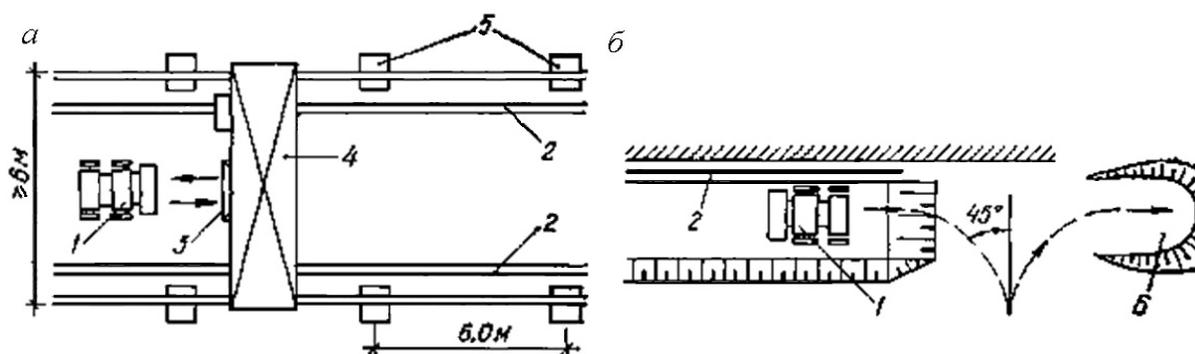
Схемы разработки грунта погрузчиком: *а* – в сочетании с мостовым краном; *б* – с доставкой грунта во временный отвал; 1 – погрузчик; 2 – шпунт; 3 – бадья; 4 – мостовой кран; 5 – колонны; 6 – временный отвал
